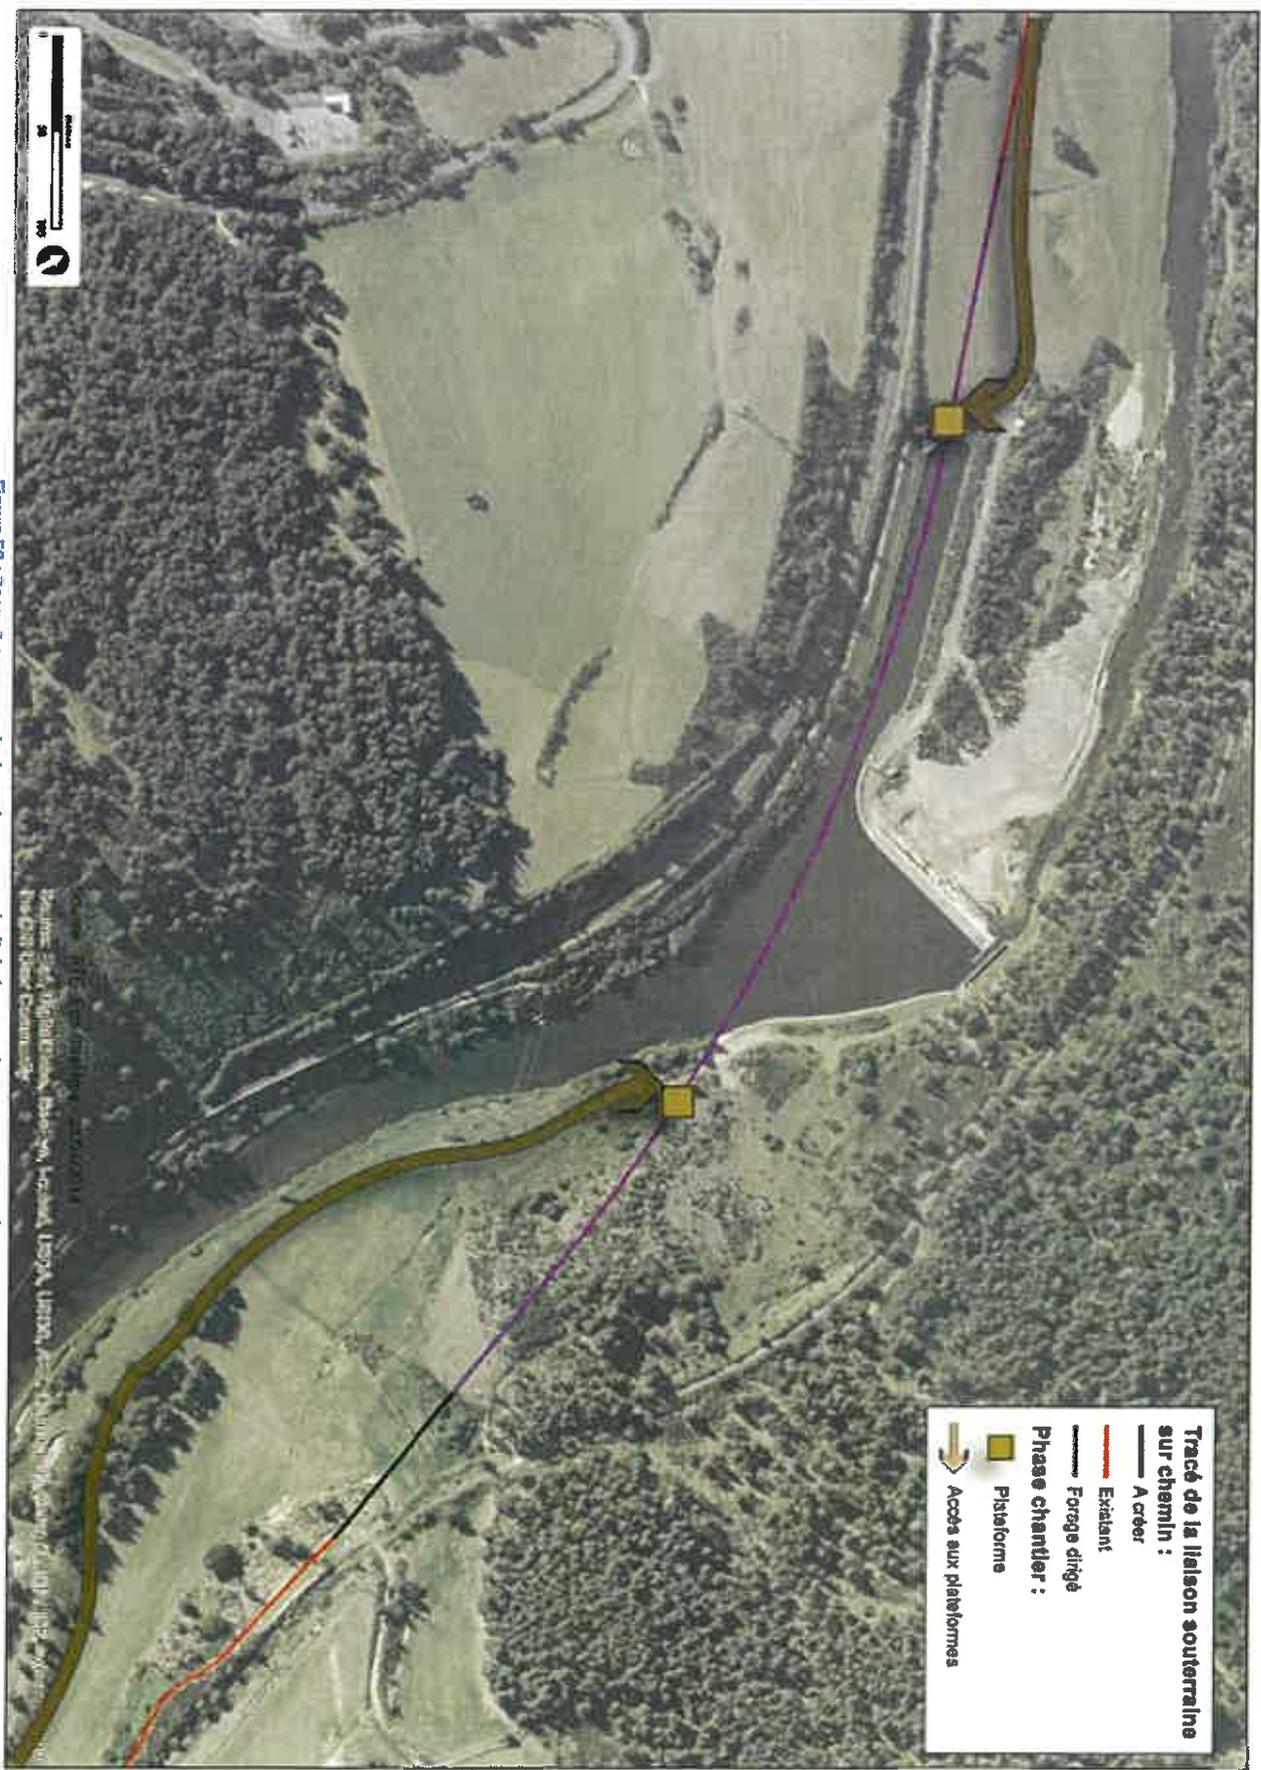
Zoom 2 correspondant aux travaux au droit du barrage de Nau ssac II (repérage sur la figure
